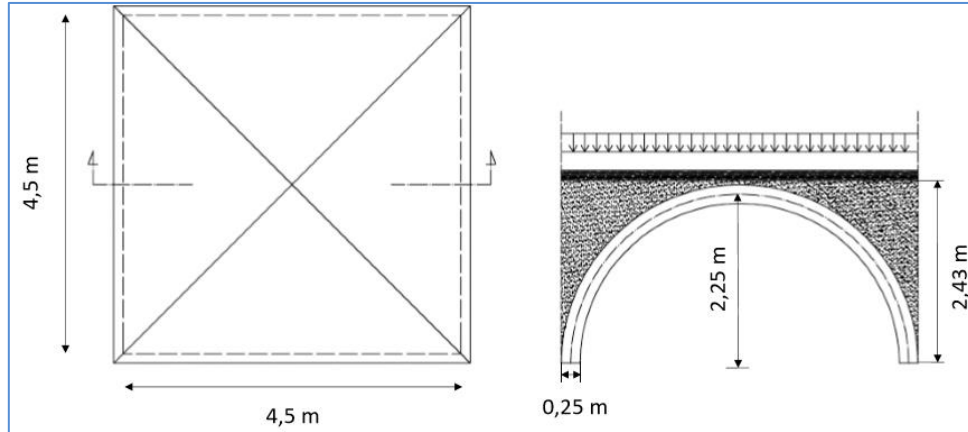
pianta e sezione della volta a padiglione oggetto di studio
